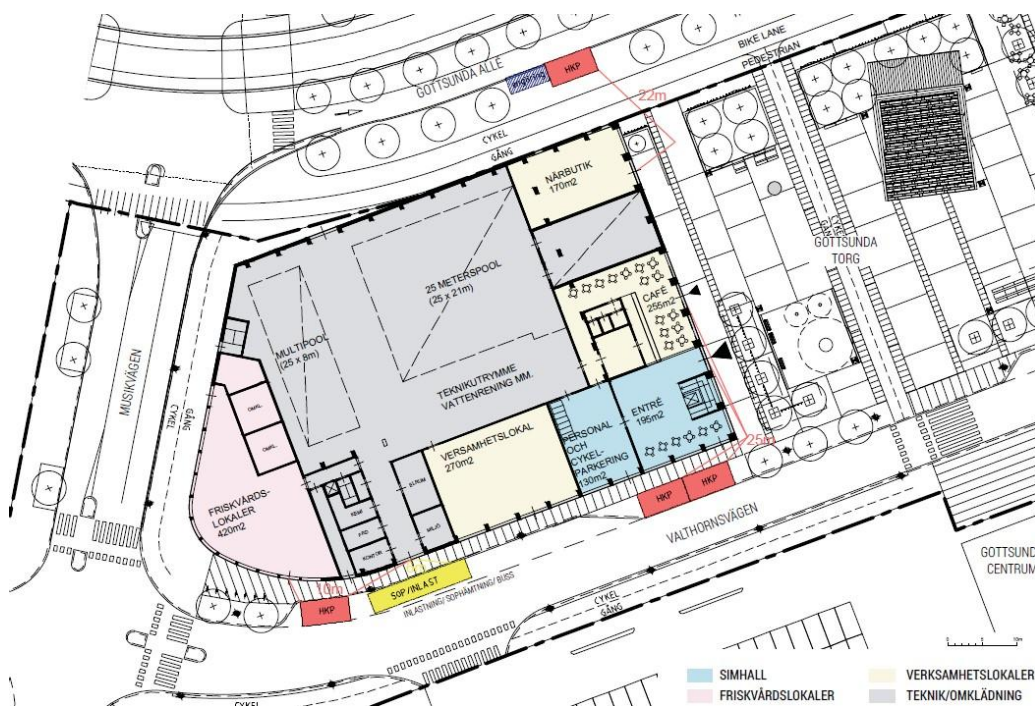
Illustrationsplan över området. Planområdet är markerat med svart streckad linje. Utanför planområdet syns en möjlig utveckling enligt den pågående detaljpaneläggning för Gottsunda stadsstråk, etapp 2 samt detaljplan för kapacitetsstark kollektivtrafik, delsträcka A-B. Bild Mandaworks + Warm in the winter.
